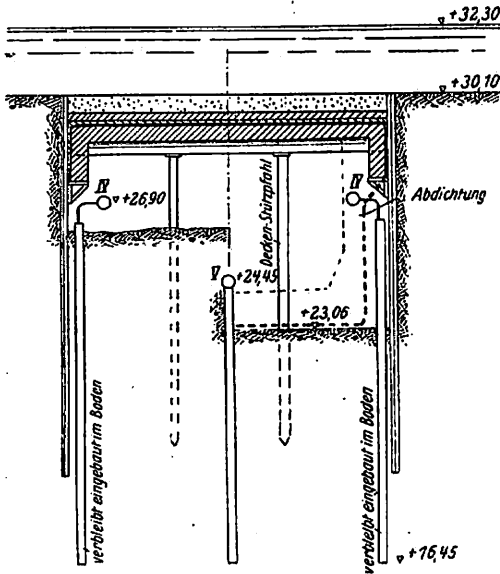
Tiefsenk-Staffeln der Landwehrkanal-Unterführung im Bauabschnitt III.
